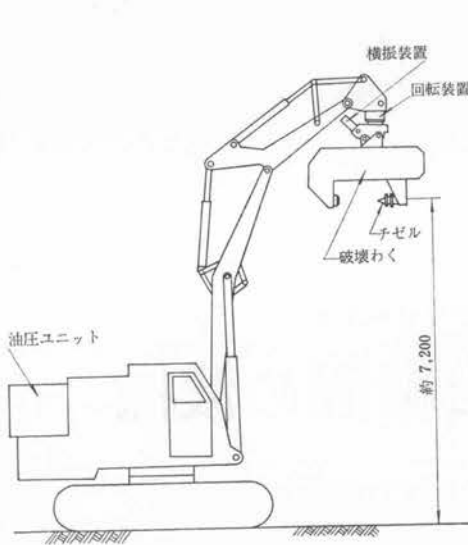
(A) コンクリート無騒音破壊機実用機 (A姿勢)
